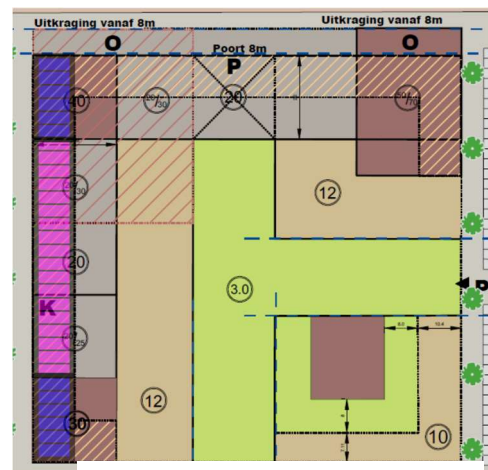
; planlocatie met de nieuw te bouwen plannen en omliggende bebouwing)
